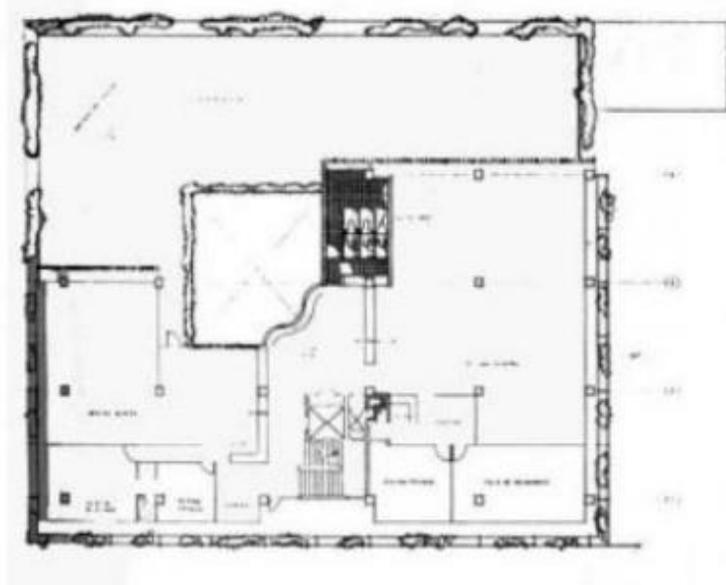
| Plano de planta alta tipo, MAG. Fuente: Libro BAQ, 1980.
